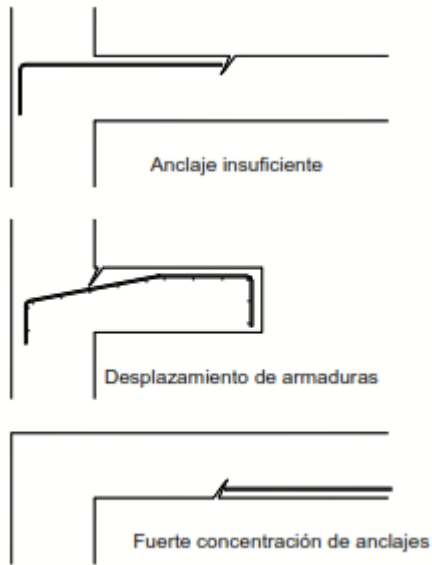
Fisuras por la mala colocación de las armaduras
